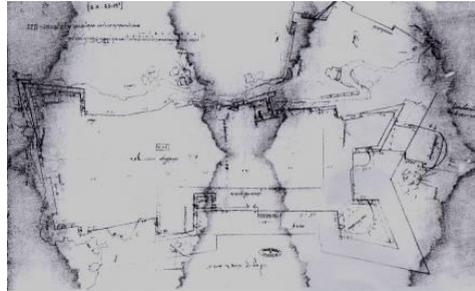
plan de la citadelle en 1535 (Epalza 1988)
